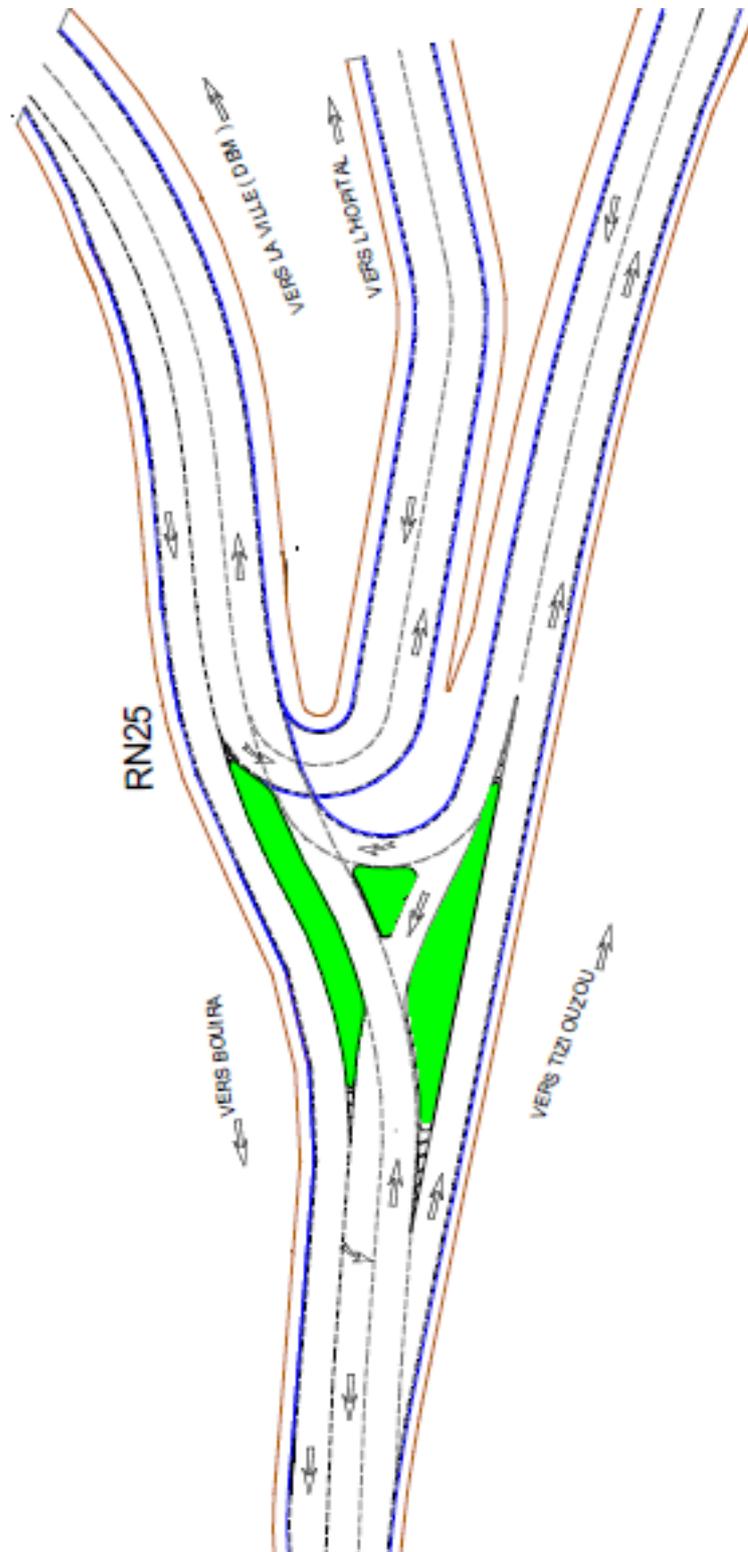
plan du carrefour plan ordinaire au PK3+019.
